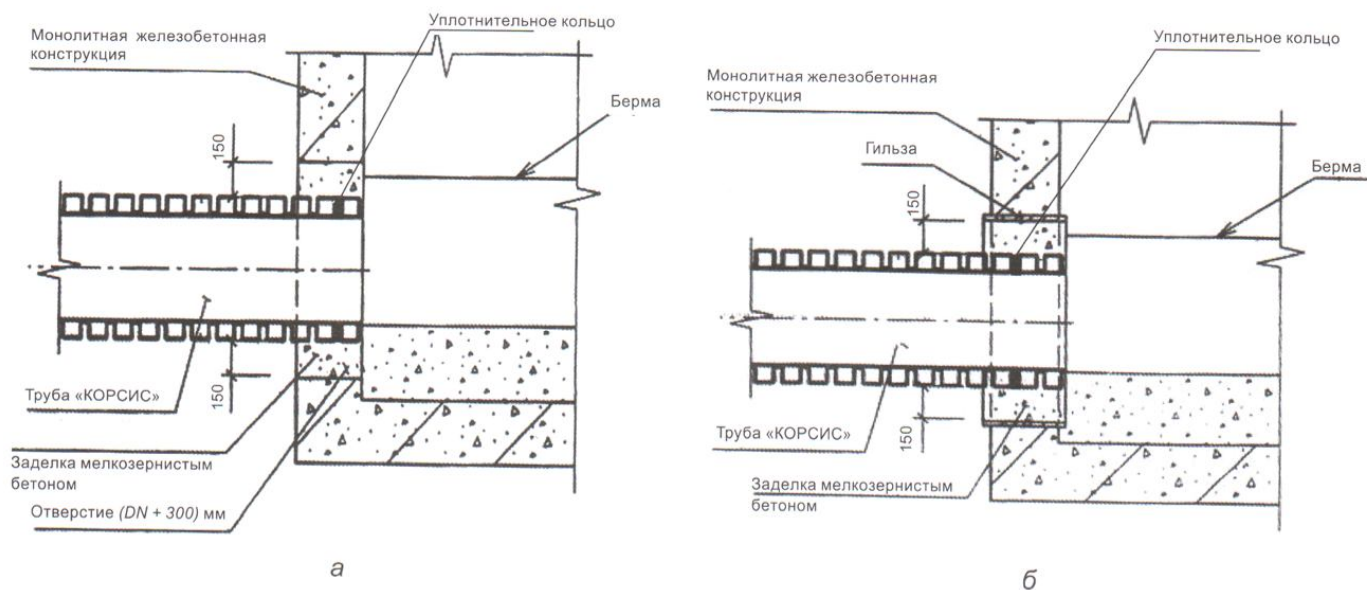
Узлы присоединения трубопроводов из труб «КОРСИС» к колодцам из монолитного железобетона:
